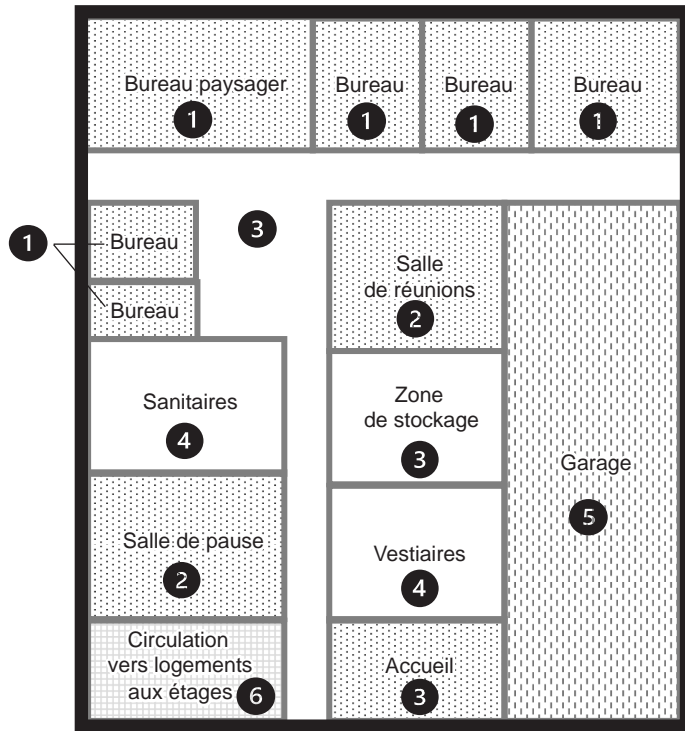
Plan d'un bâtiment de caserne des pompiers (extrait)
